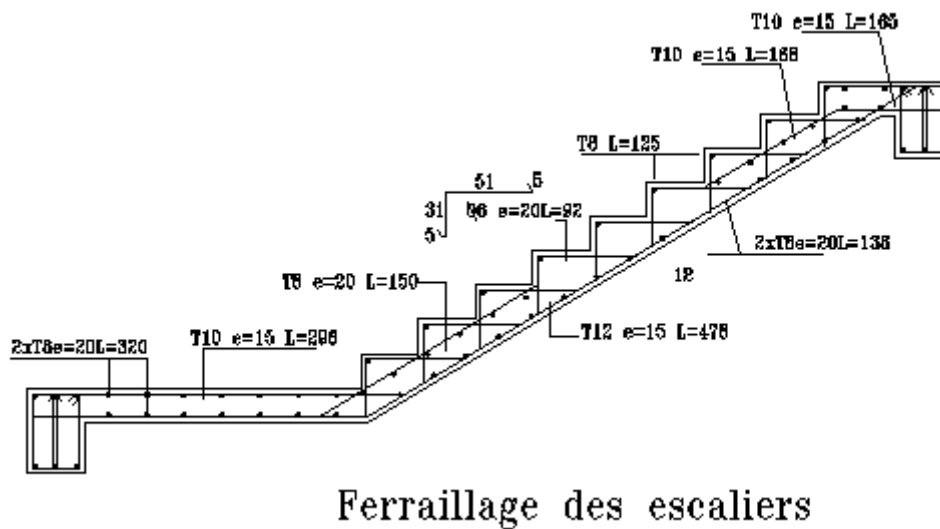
schéma de ferrailage de l'escalier et poutre palière.
